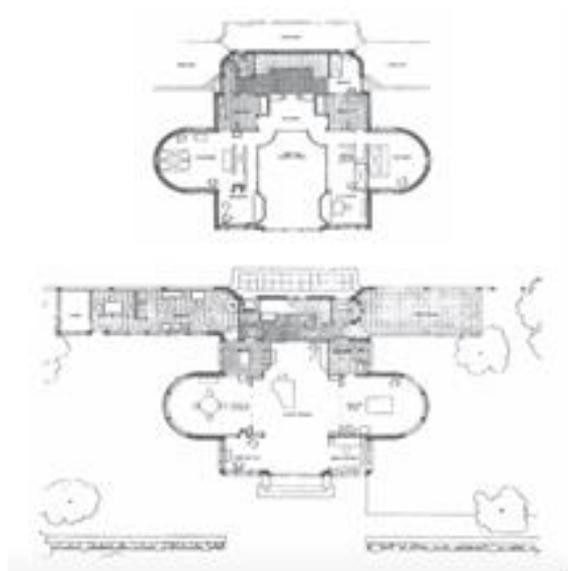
Plantas do piso térreo (em baixo) e 1º piso (em cima) da Villa Schowb
